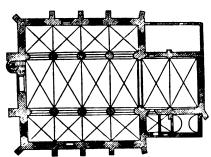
Wiek. Kirche. Grundriss. 1:667.
